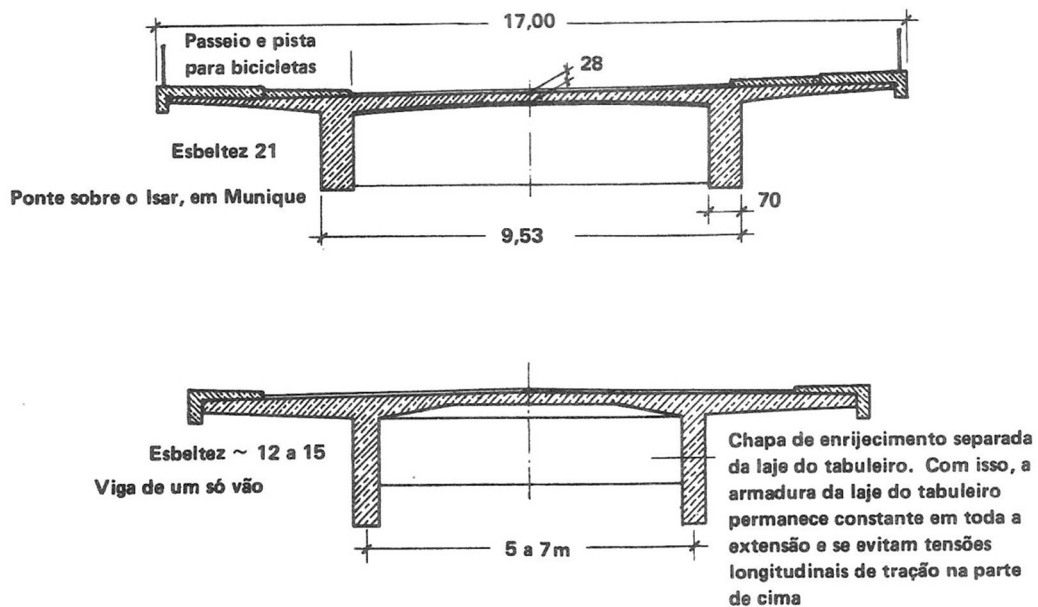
Superestrutura em viga sem transversina (LEONHARDT, 1979)
